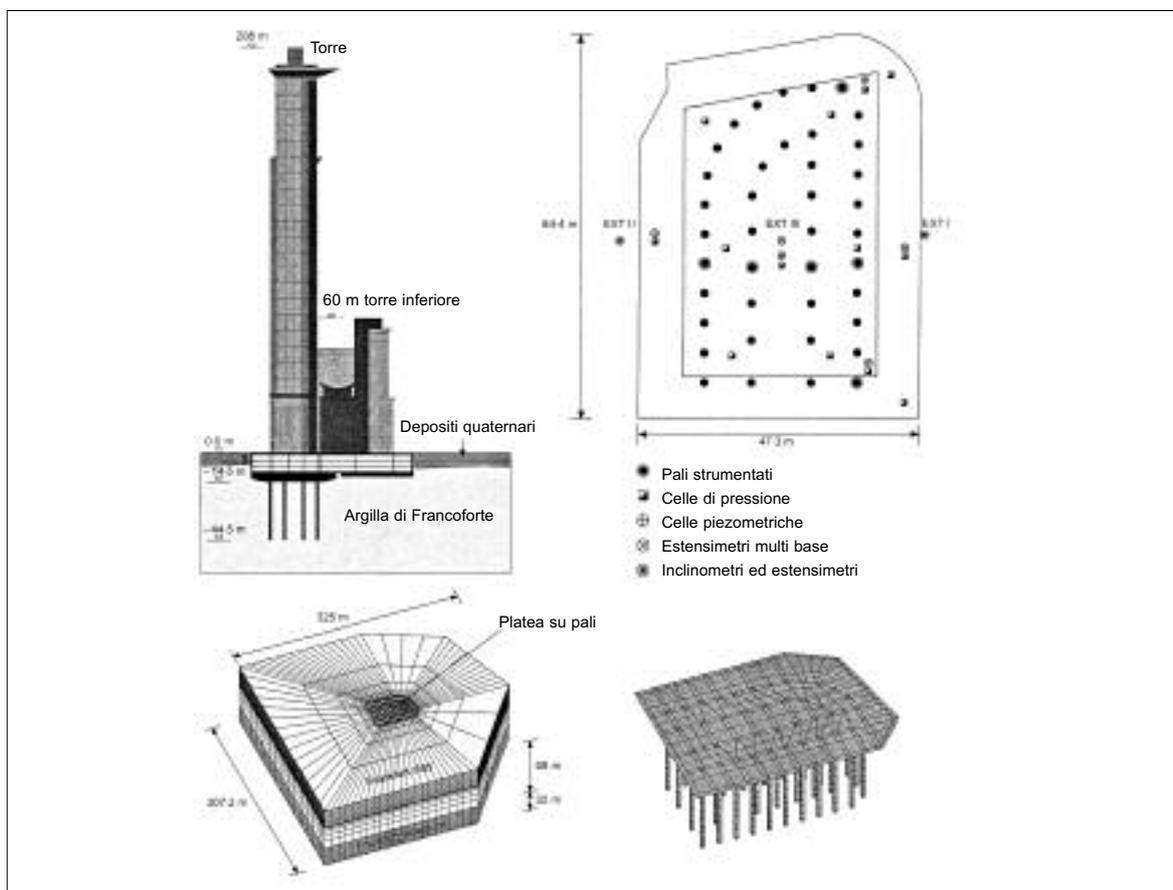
Complesso di Westend 1: (a) sezione trasversale; (b) pianta della piastra di fondazione della torre con l'indicazione della strumentazione di controllo; (c) reticolo di elementi finiti per l'analisi numerica con programma agli elementi finiti; (d) discretizzazione con gli elementi finiti della piastra di fondazione e dei pali
